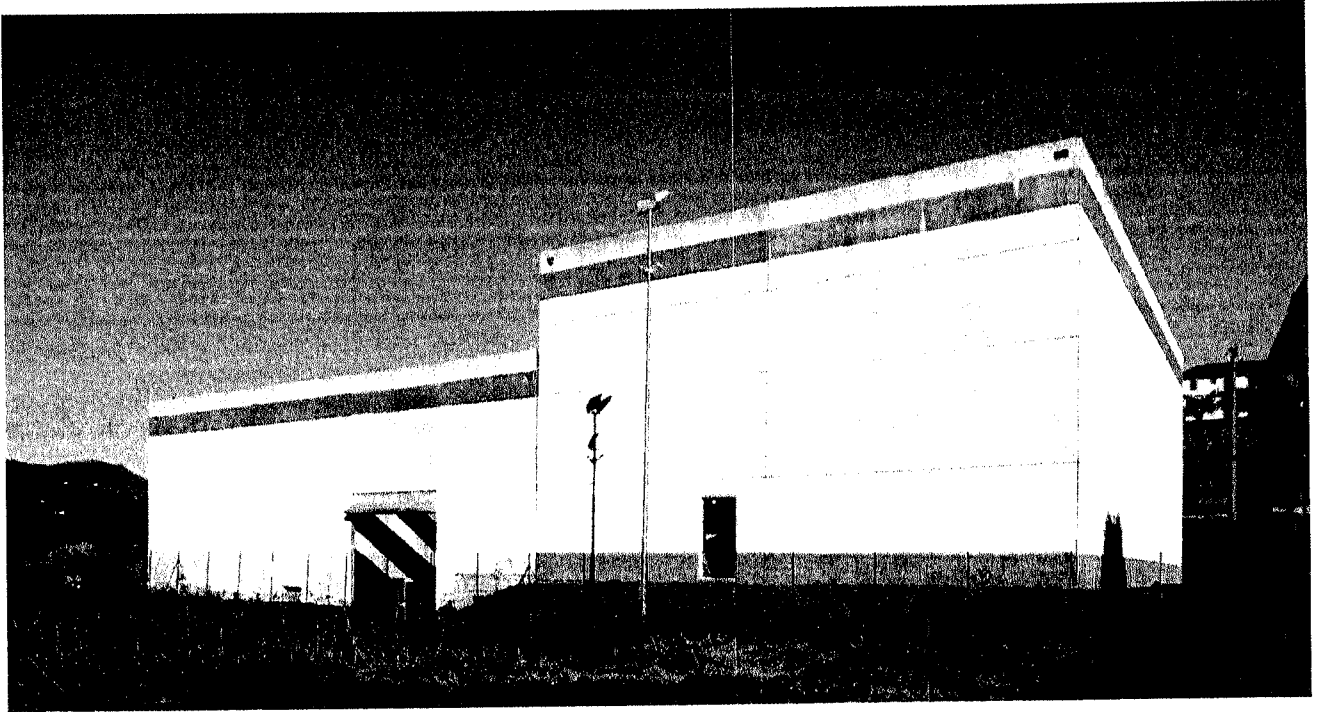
VISTA DA SUD DEL FABBRICATO NON ULTIMATO (mappale 6816)
